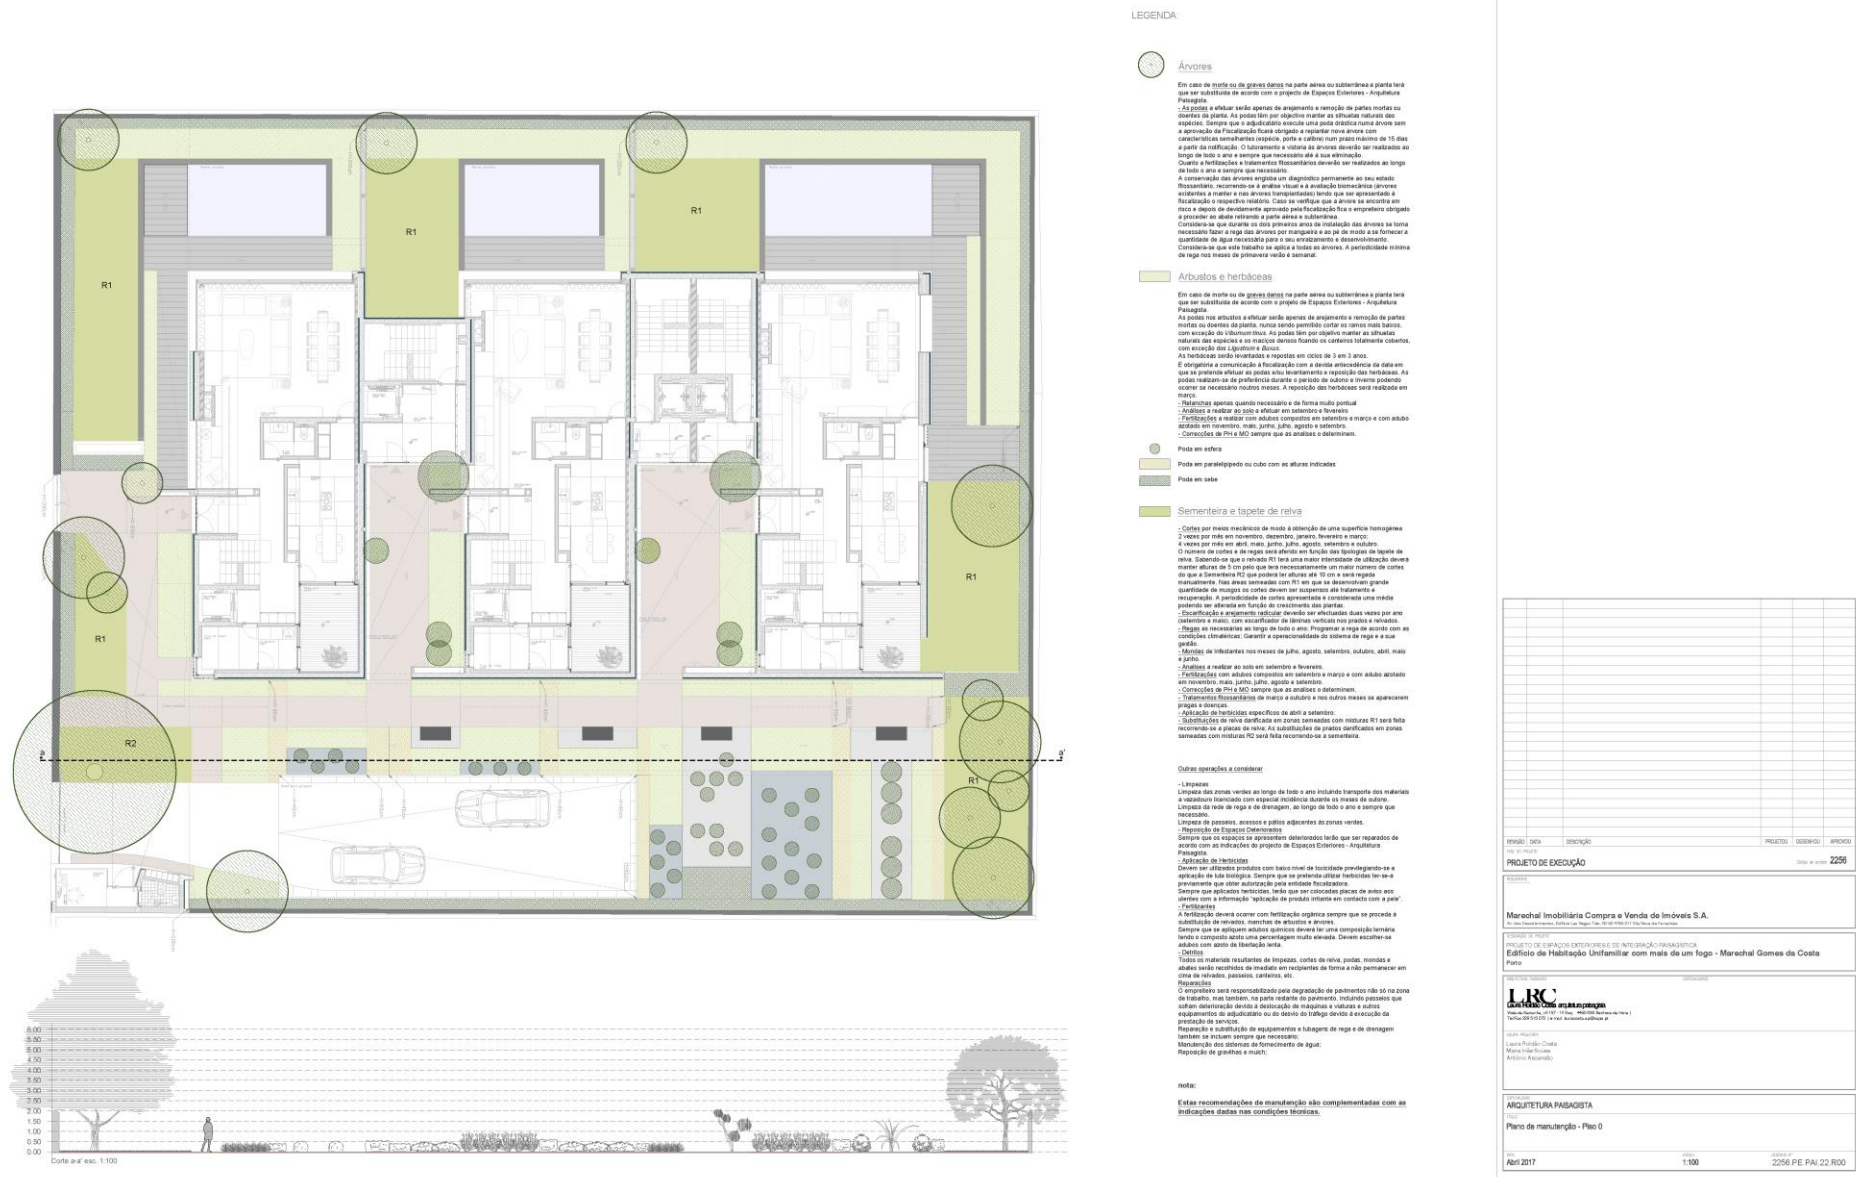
Planimetria dos bancos e lajes de drenagem do Projeto Marechal 1000.
